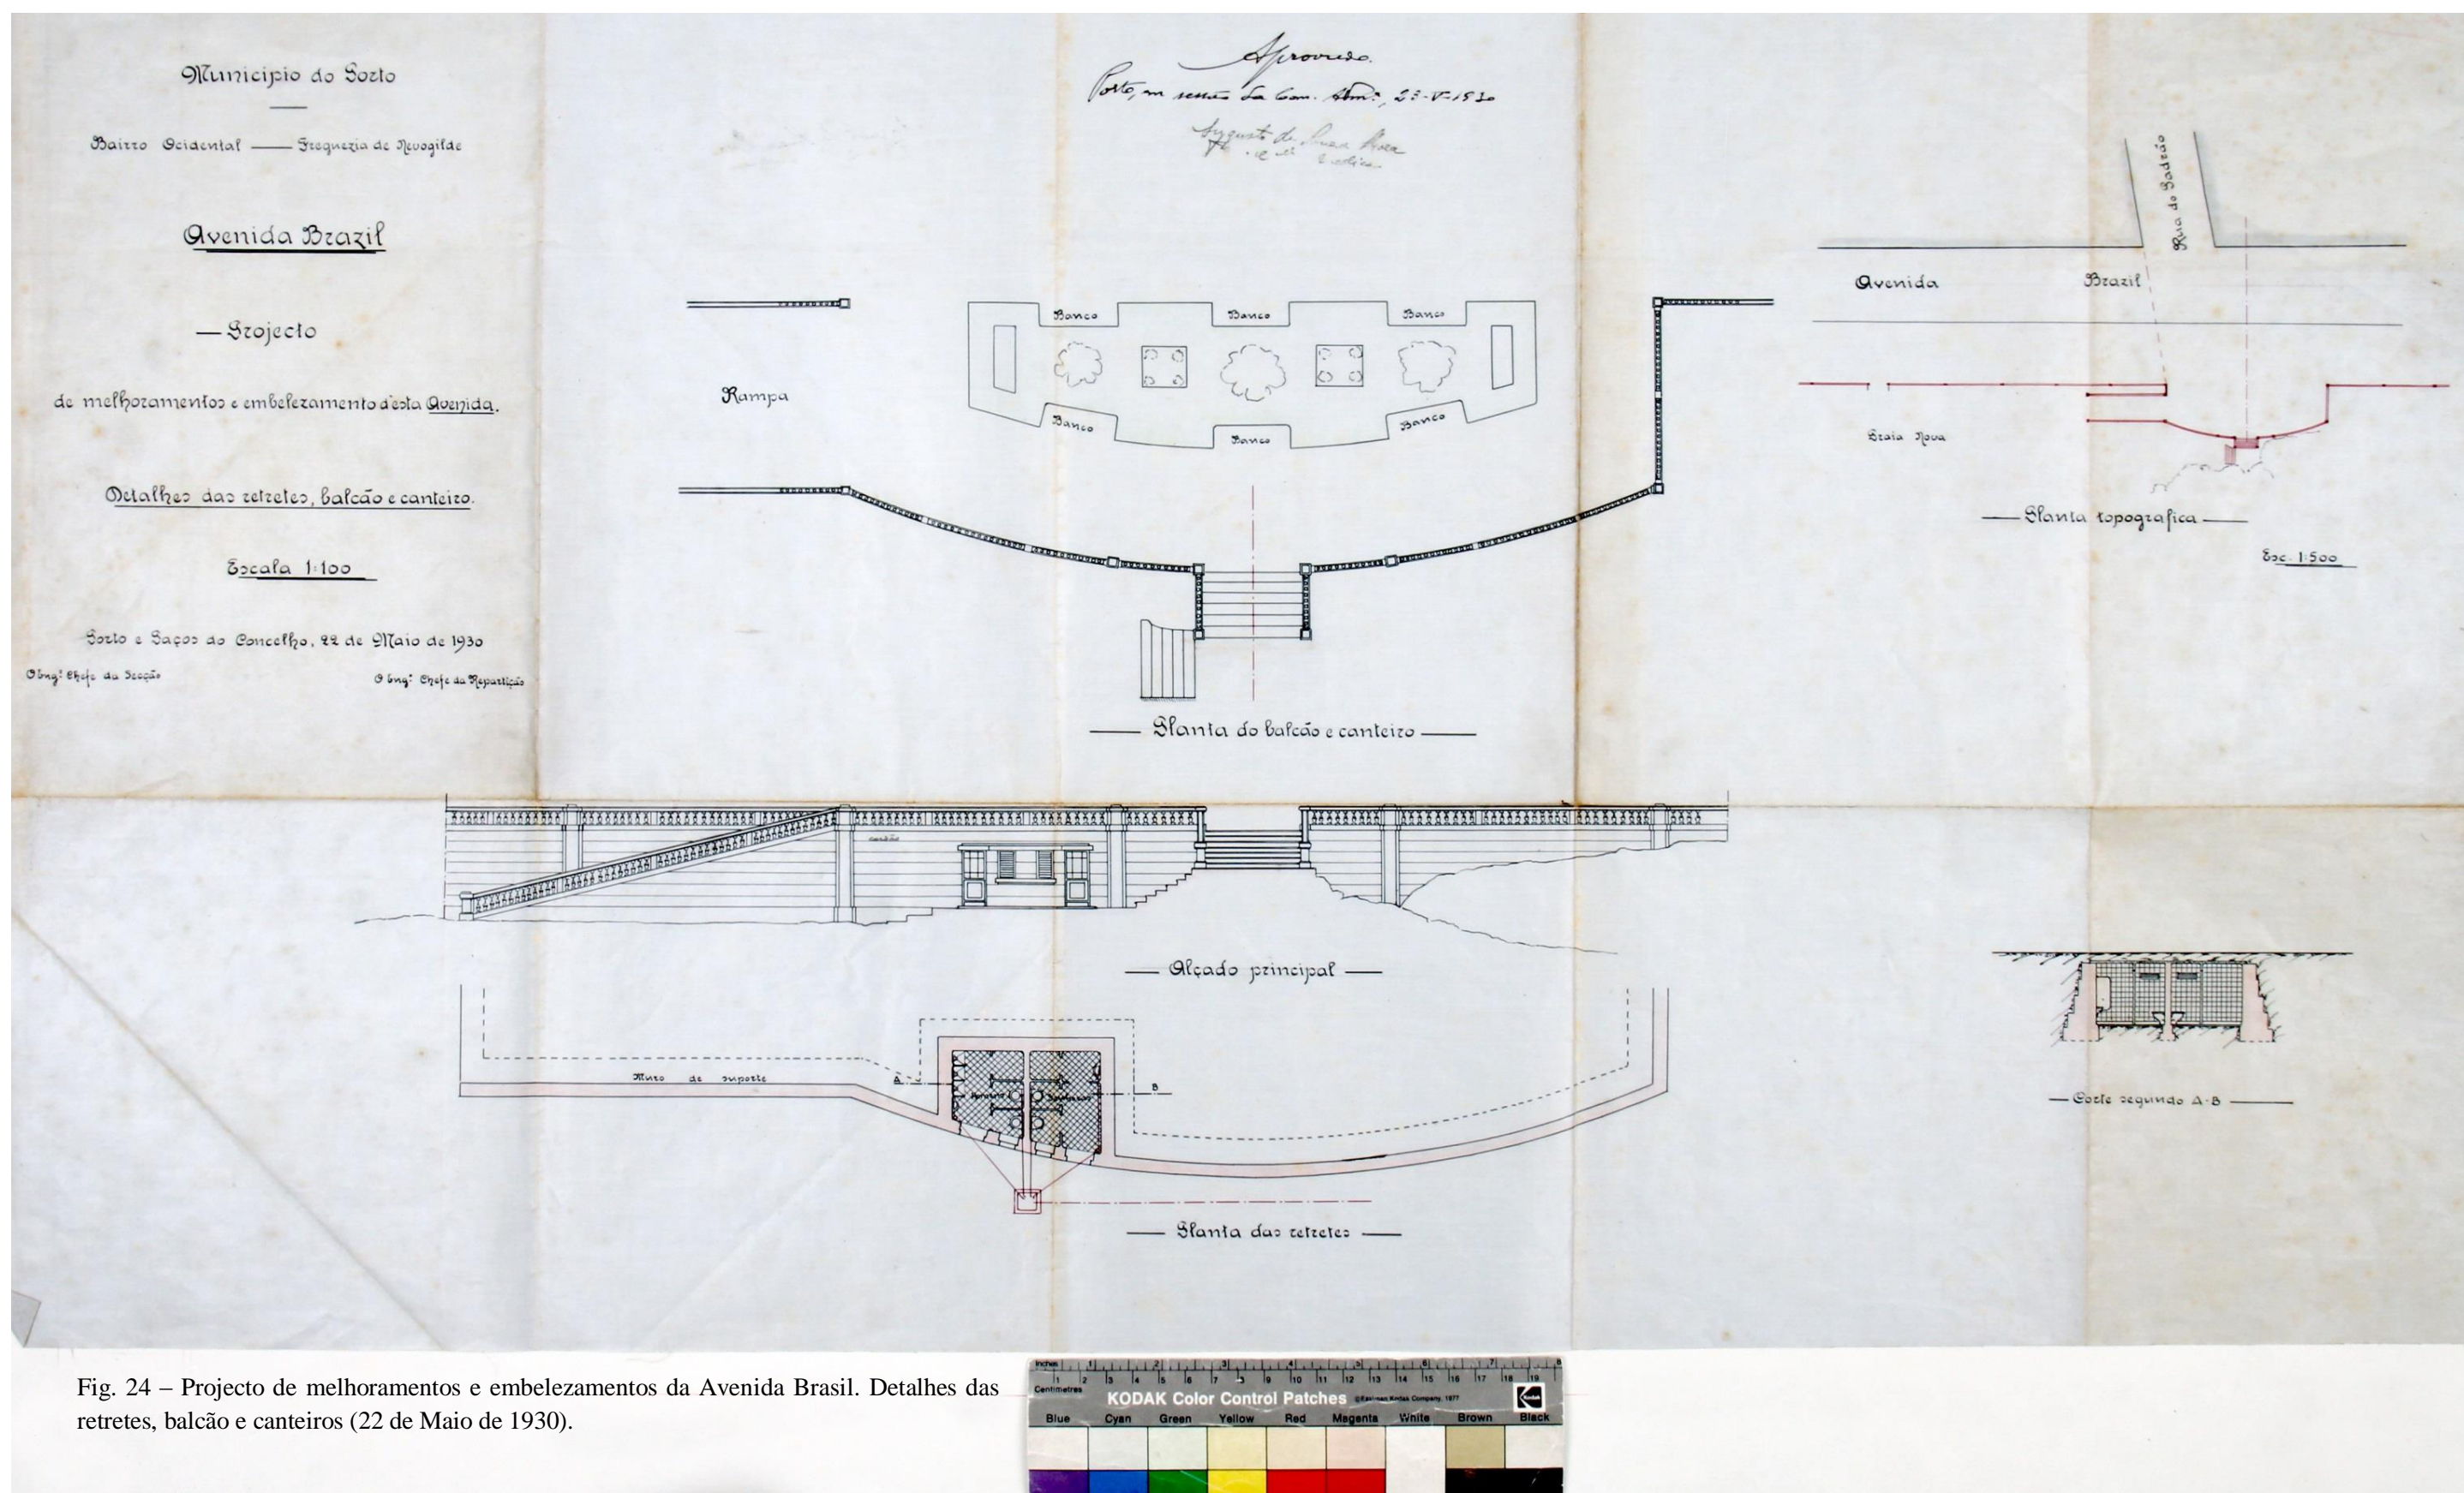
Projecto de melhoramentos e embelezamentos da Avenida Brazil. Detalhes das retretes, balcão e canteiros (22 de Maio de 1930).
